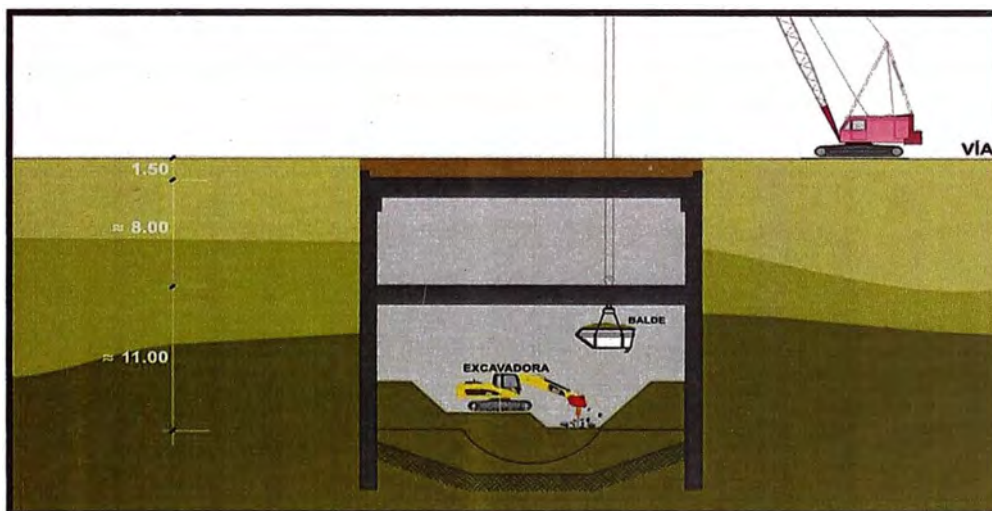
Esquema de la Excavación hasta el nivel de losa de fondo.
